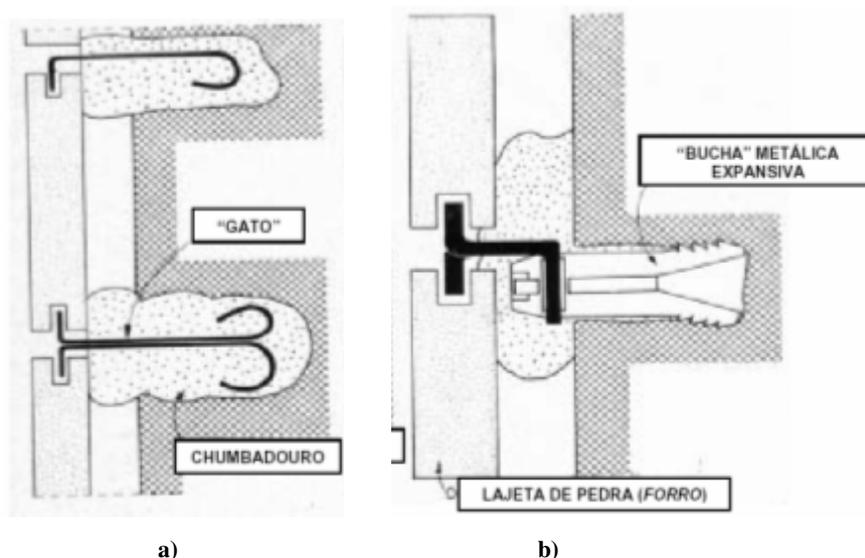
Sistema de fixação de placas de pedra através de elementos metálicos; a) Gatos com chumbadouro; b) Fixação metálica com bucha metálica expansiva.
